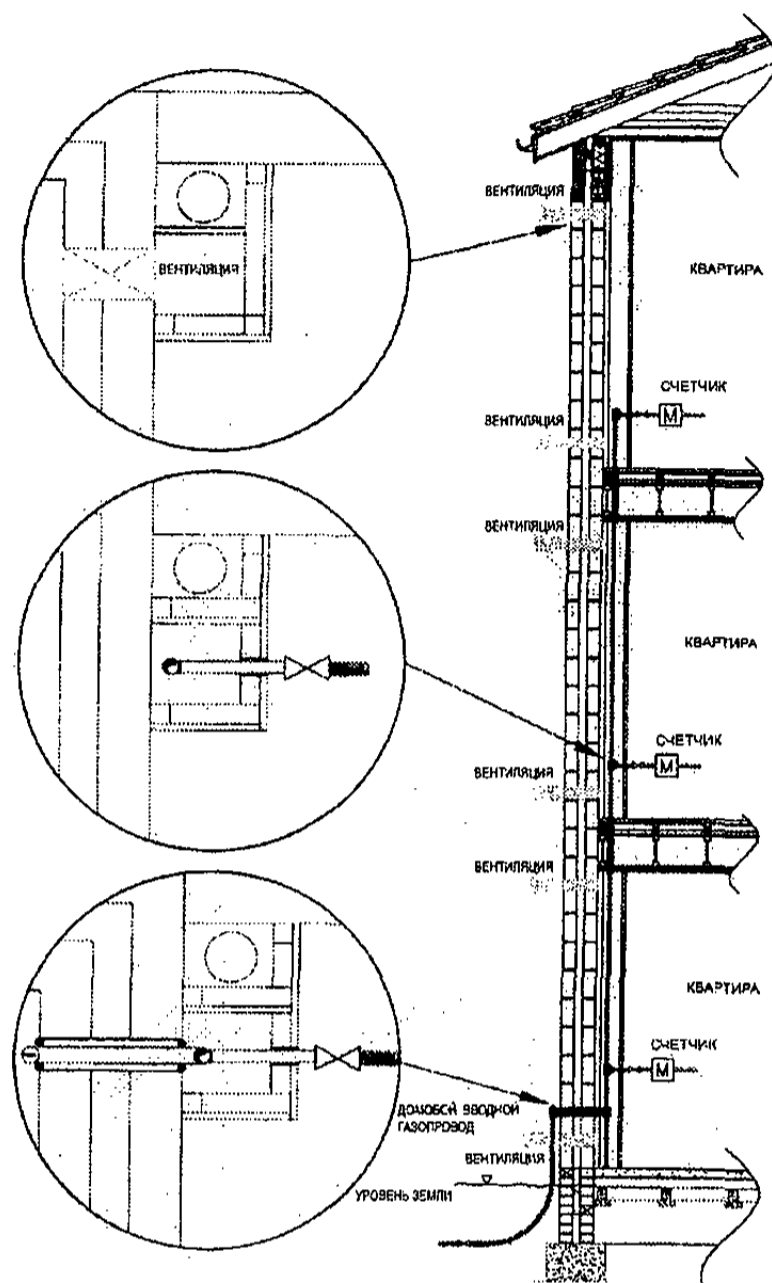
Газопровод в вентилируемой штрабе
